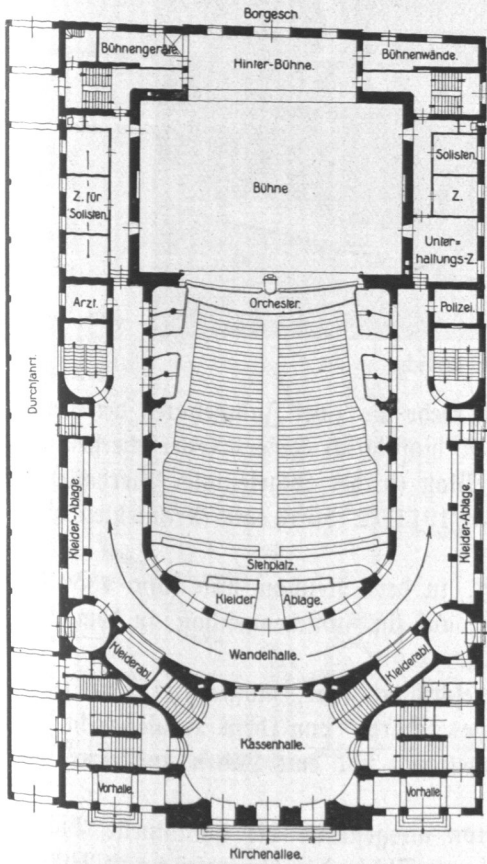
Deutsches Schauspielhaus, Erdgeschoß, Grundriß.
